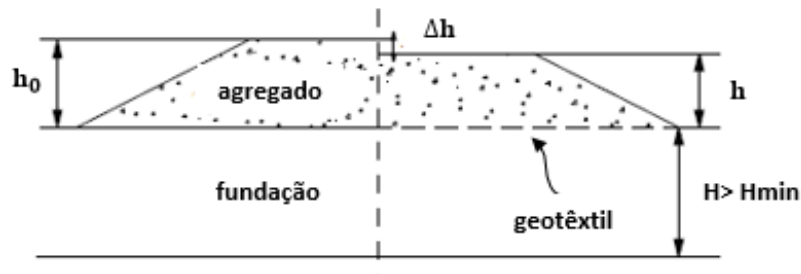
Geometria da estrada não pavimentada com e sem geotêxtil (adaptado de GIROUD e NOIRAY, 1981).
